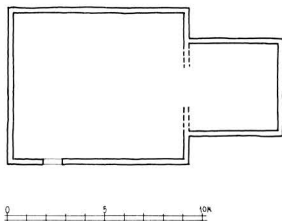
Den ursprungliga träkyrkans grundplan, 1 : 400.
